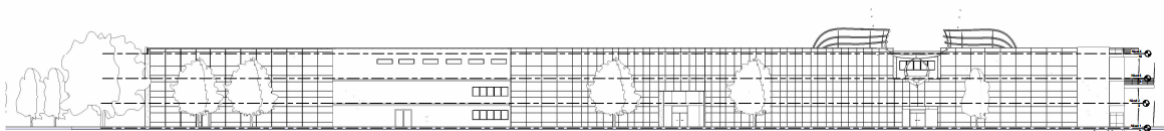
Fachada Principal, su vista hacia el parque permite una mayor apertura visual y su orientación norte permite el aprovechamiento de la luz solar para la generación eléctrica.
